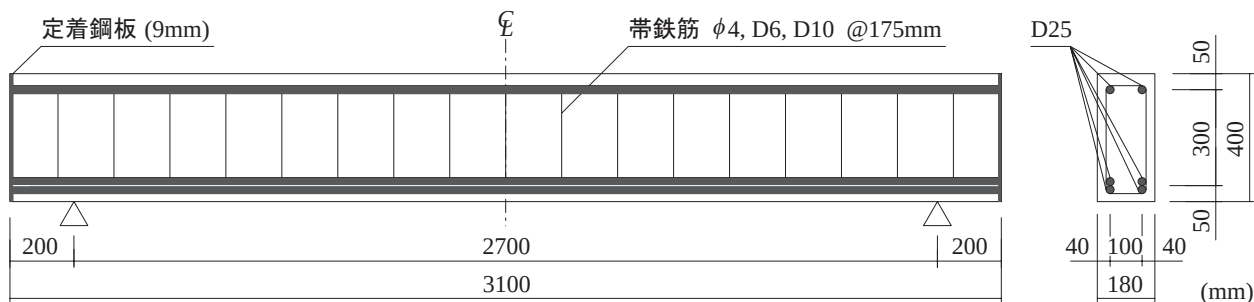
試験体の形状寸法および配筋状況 (D4, D6, D10)
